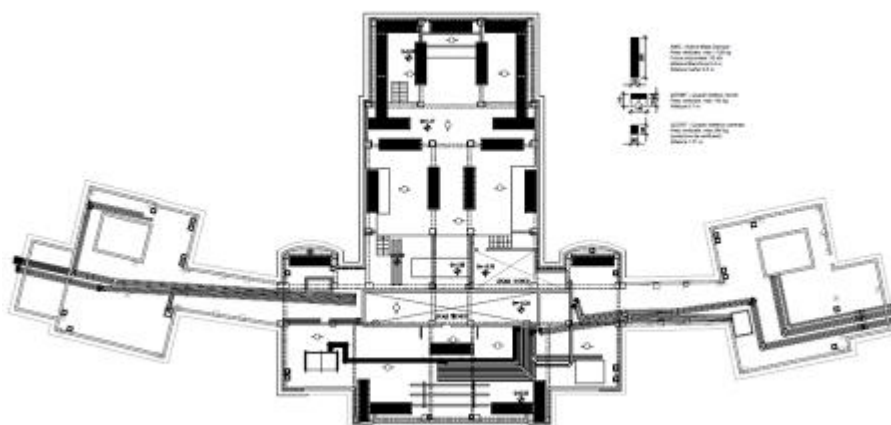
Disposizione planimetrica delle 24 unità macchina del sistema attivo Electro-Pro 20x o similare
